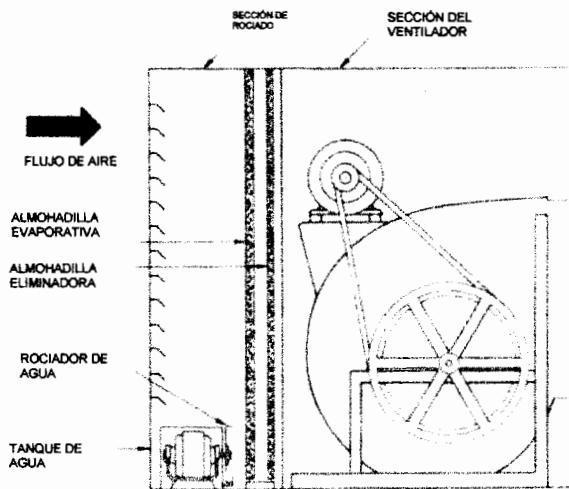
PAQUETES ENFRIADORES DE AIRE CON ROCIADOR CENTRÍFUGO (SLINGER PACKAGED AIR COOLERS)
